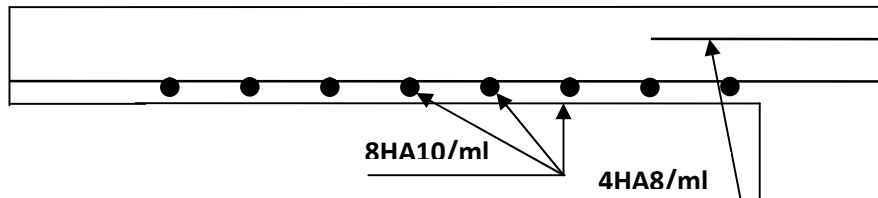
Schéma de ferrailage du deuxième type de balcon.
